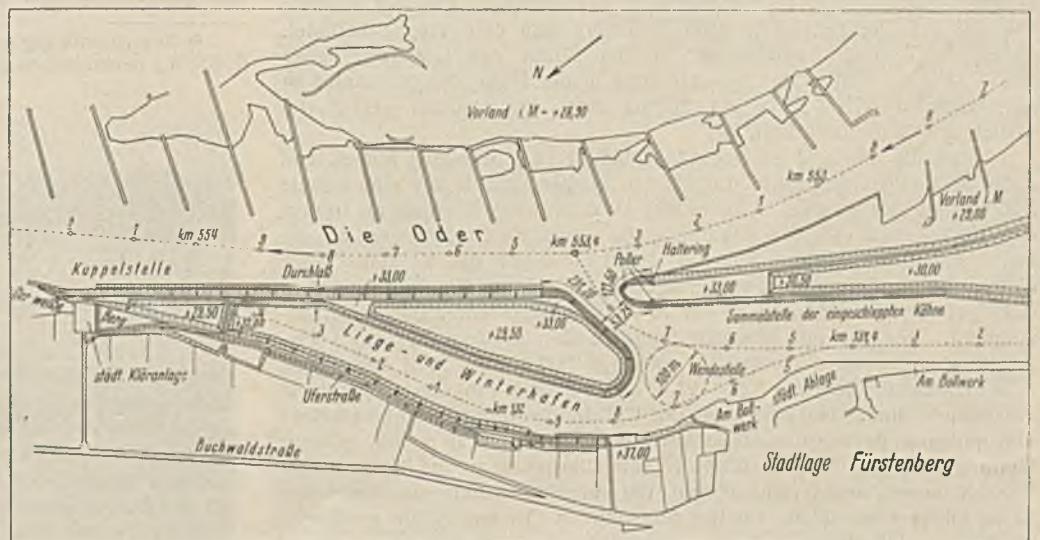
Lageplan der Einfahrt und des Liegehafens einschließlich Uferstraße.
